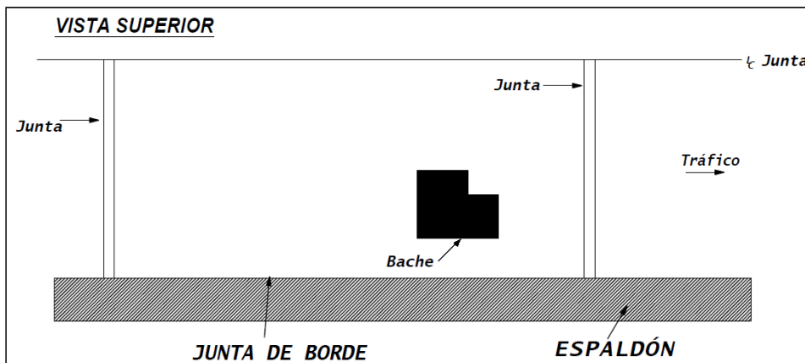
Esquema Baches menores a 0,5 m² - Pavimento Rígido Continuo
